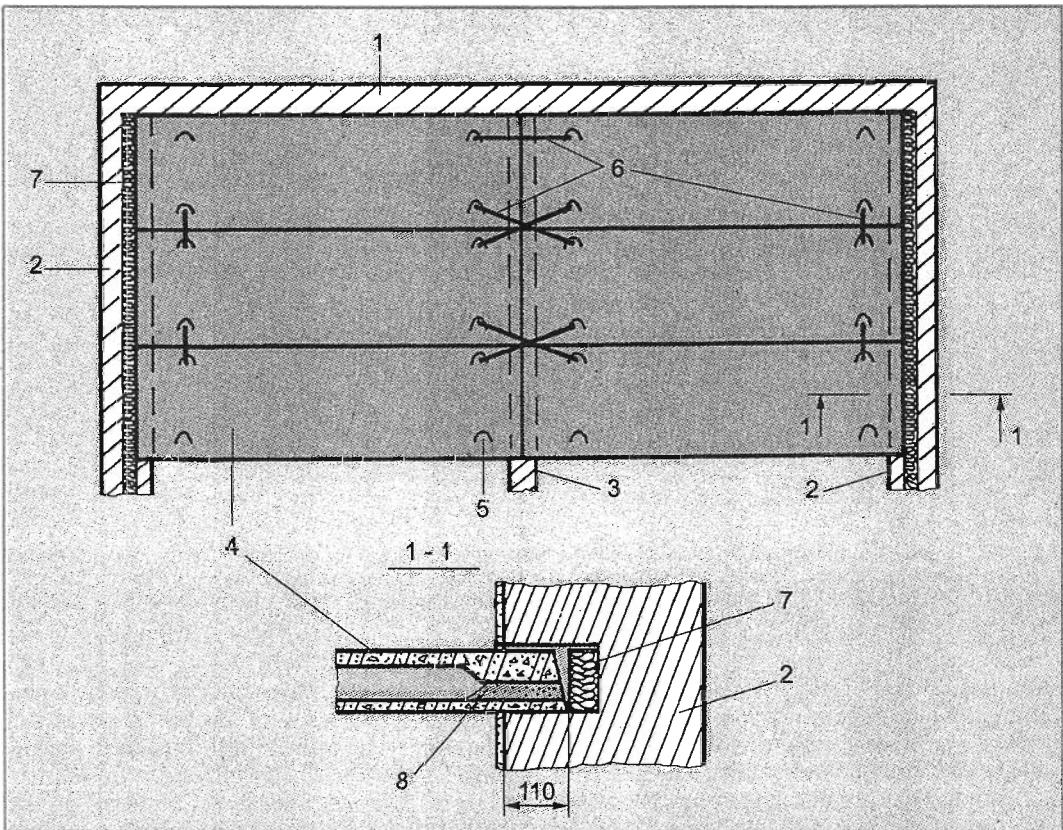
Фрагмент плана перекрытия из железобетонных плит: 1 – наружная самонесущая стена; 2 – наружная несущая стена; 3 – внутренняя несущая стена; 4 – железобетонная плита перекрытия; 5 – монтажные петли; 6 – проволочная ($d = 6$ мм) скрутка; 7 – теплоизоляционный вкладыш, прерывающий мостик холода; 8 – раствор
